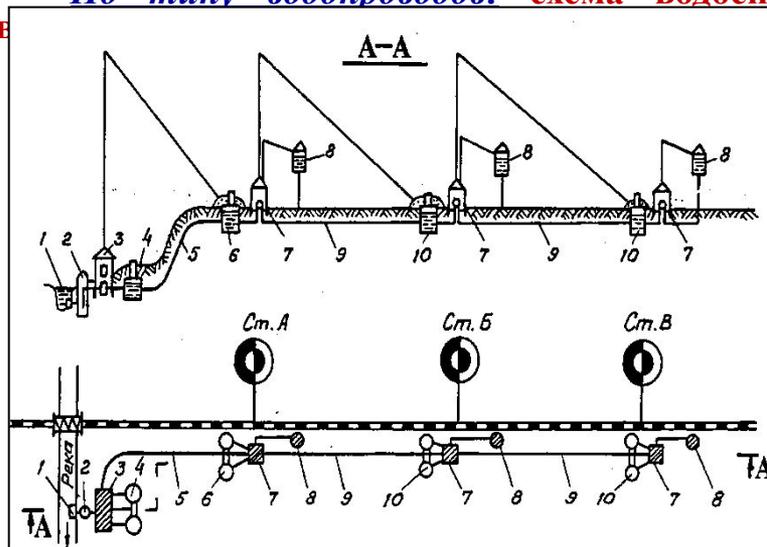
Схема централизованного водоснабжения с продольными водопроводами
